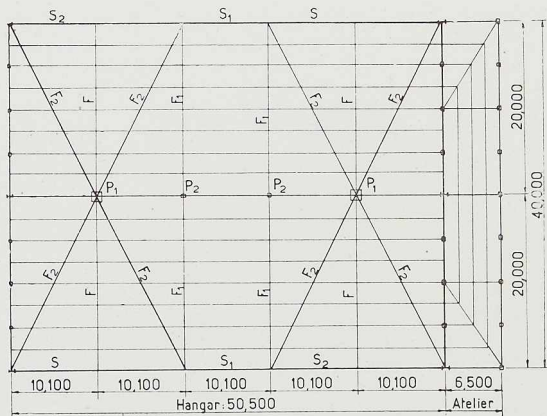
à 694. Ci-dessus : coupe transversale. Ci-contre : vue en plan montrant la disposition de la charpente métallique. P₁ : poteaux principaux; F₂ : fermes-bascules; F et F₁ : fermes transversales; S, S₁, S₂ : sablières. Ci-dessous : coupe longitudinale.
